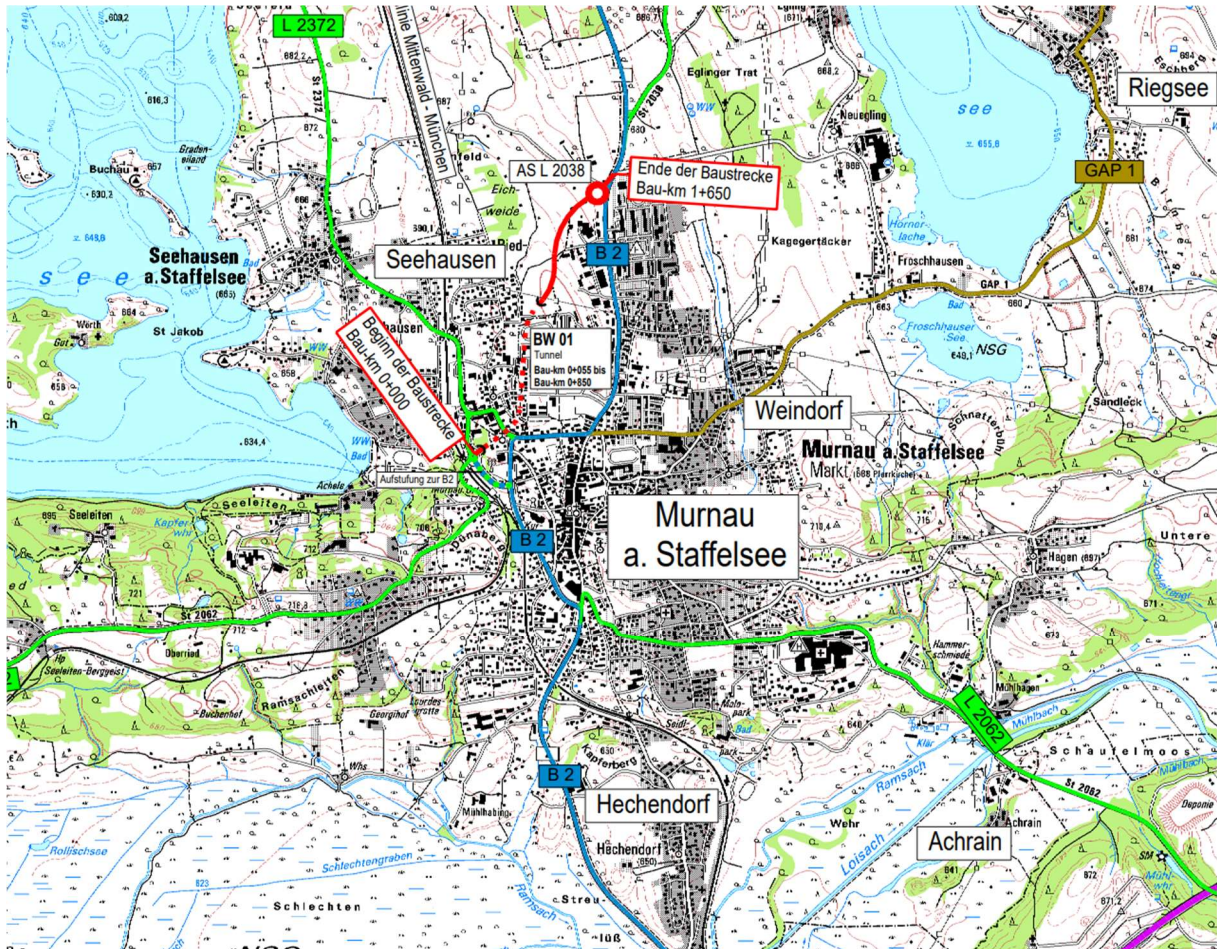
Übersichtsplan Projekt B 2 Nordumfahrung Murnau – Ausschnitt aus BVWP 2030.
